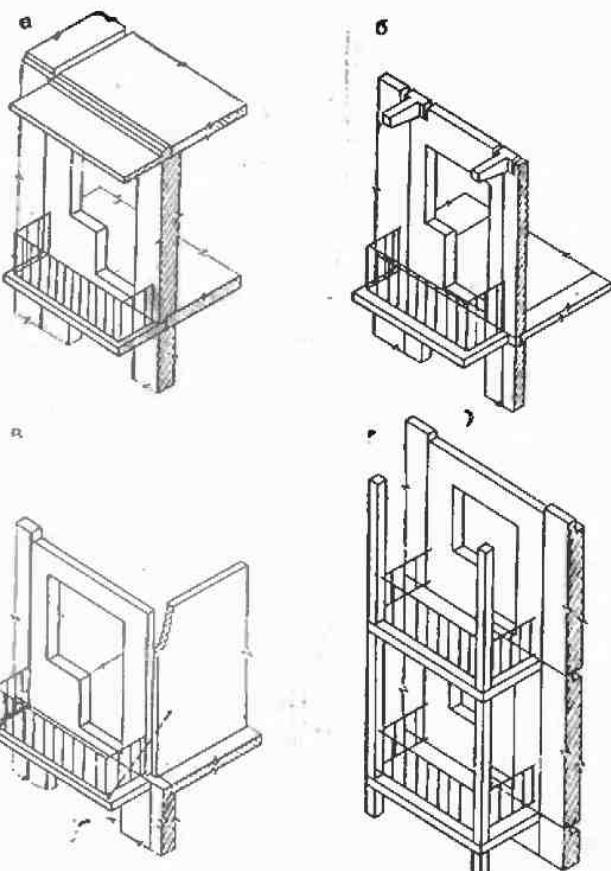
Устройство балконов в бескаркасных крупнопанельных зданиях
